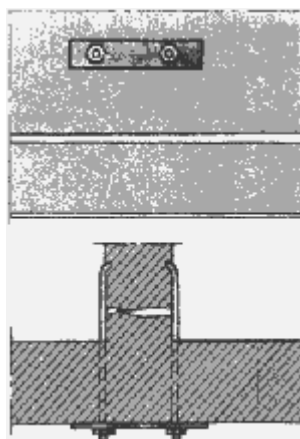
Усиление кирпичной стены металлическими накладками при отрыве поперечной стены.
